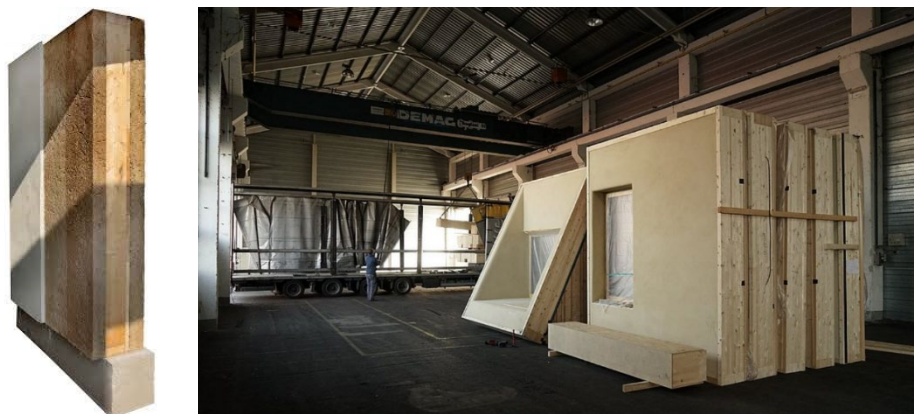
Außenwandsysteme mit Lehm: Holz-Lehm-Verbundbauteil (©Andi Breuss), Vivihouse, Holz-Lehm-Fertigteile für den Geschosswohnbau (@vivihouse.cc)
